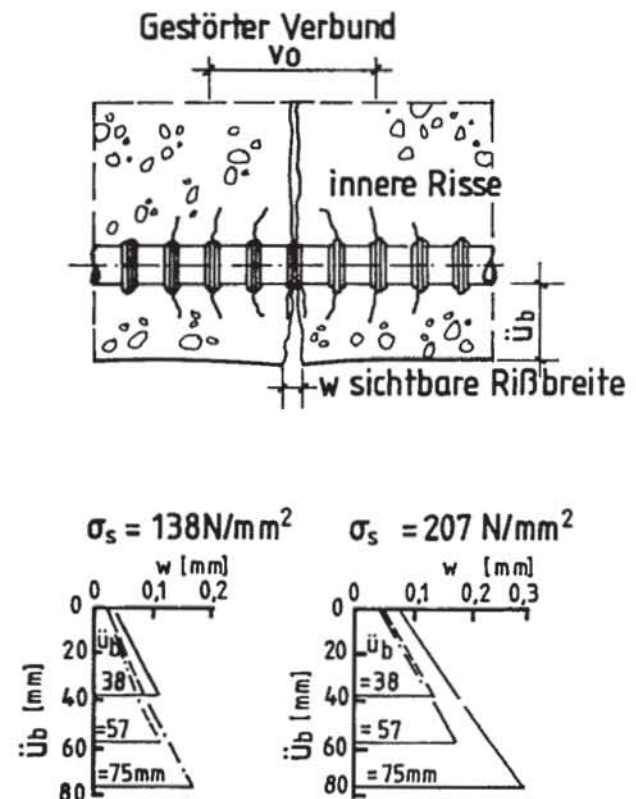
Abnahme der RiBbreite von der Betonoberfläche hin zum Bewehrungsstab, je nach Stahlspannung und Betondeckung (nach Leonhardt (1977) und Beeby (1978))
